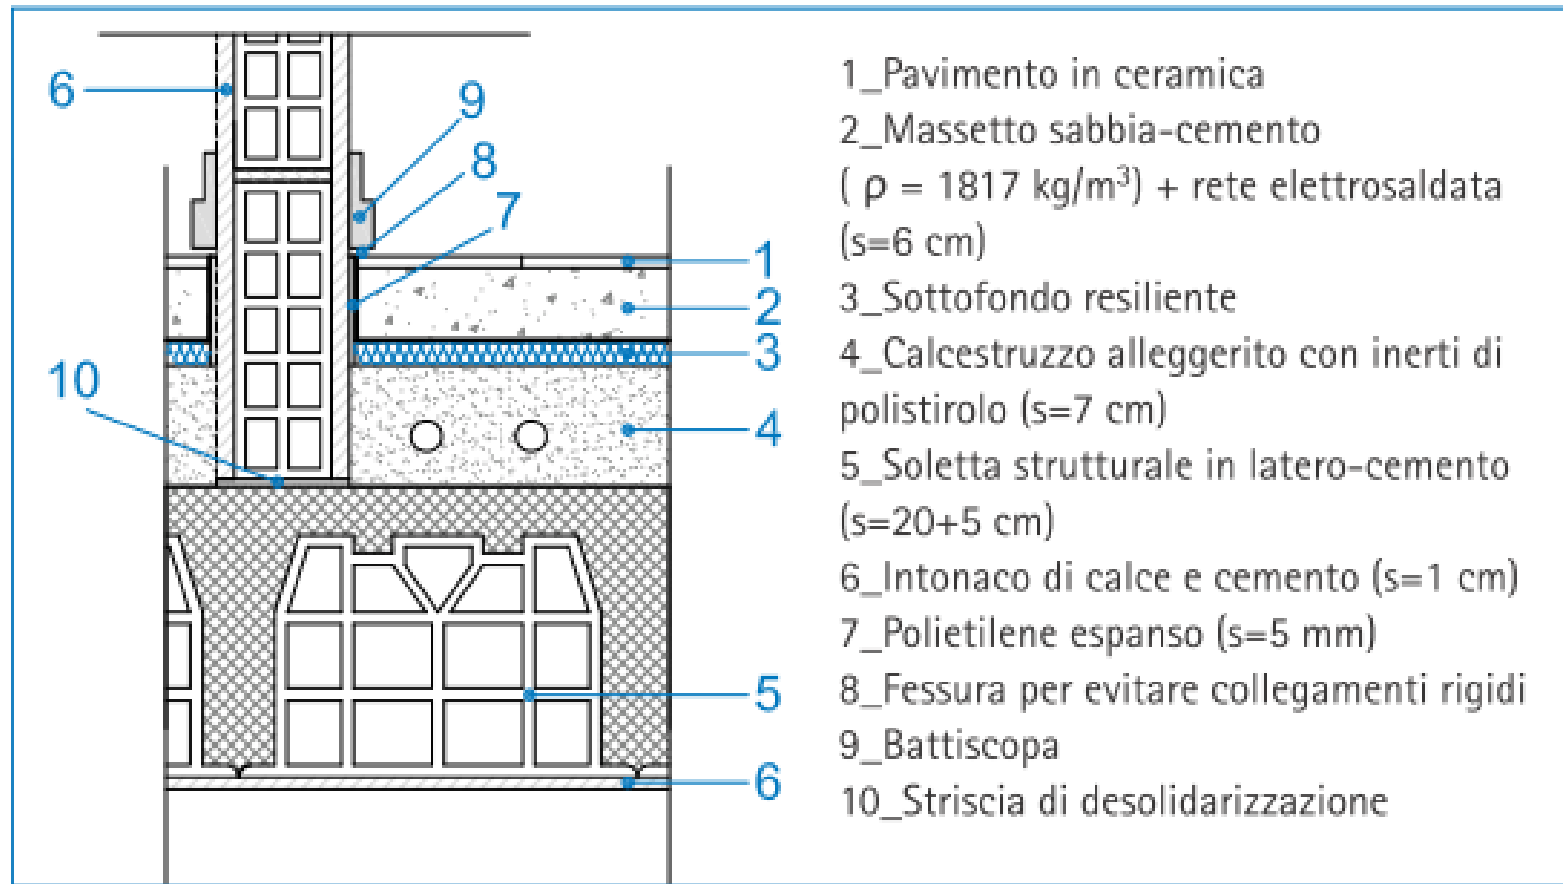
esempio di realizzazione di pavimento galleggiante su soletta in laterocemento con parete verticale in muratura.
